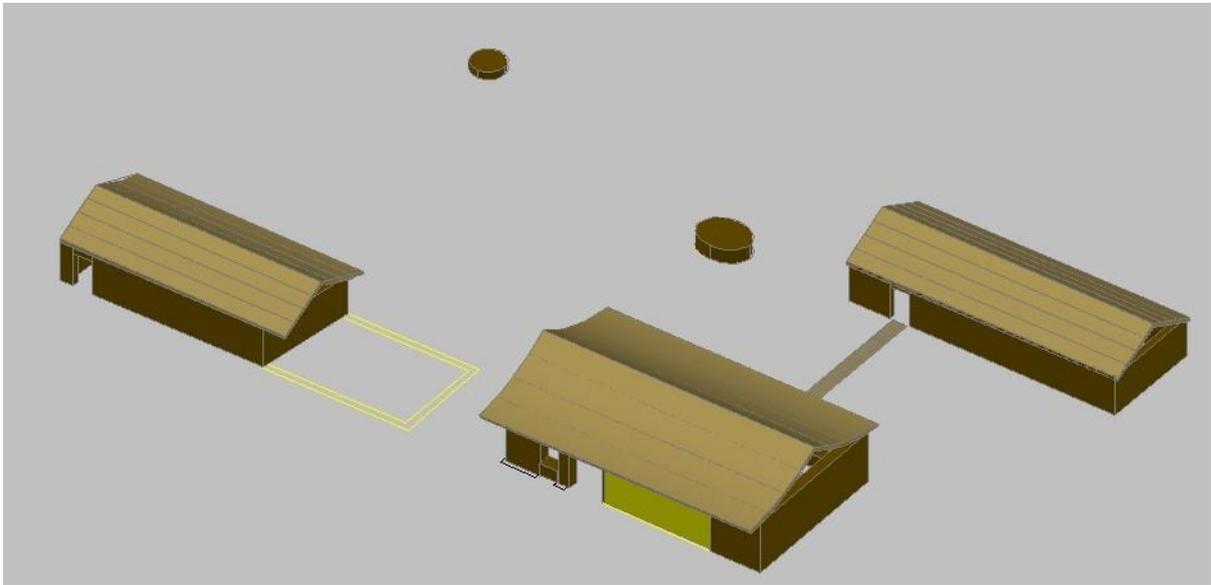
Croqui em 3D da Estância do 28 – Alegrete (RS)
